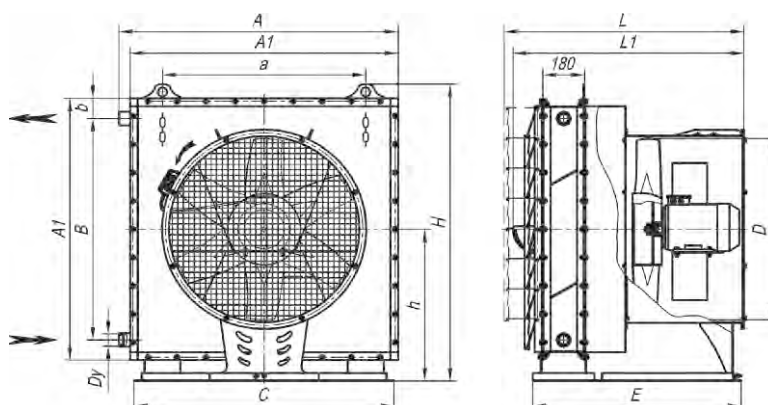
Габаритные и присоединительные размеры агрегатов А02 на базе калориферов типа КСк.
